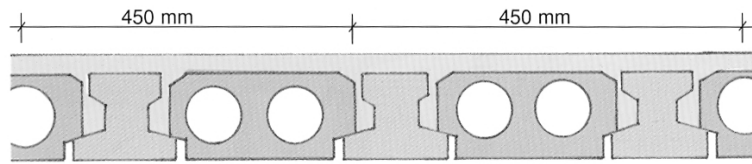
Prefabrike betonarme döşeme [23].
